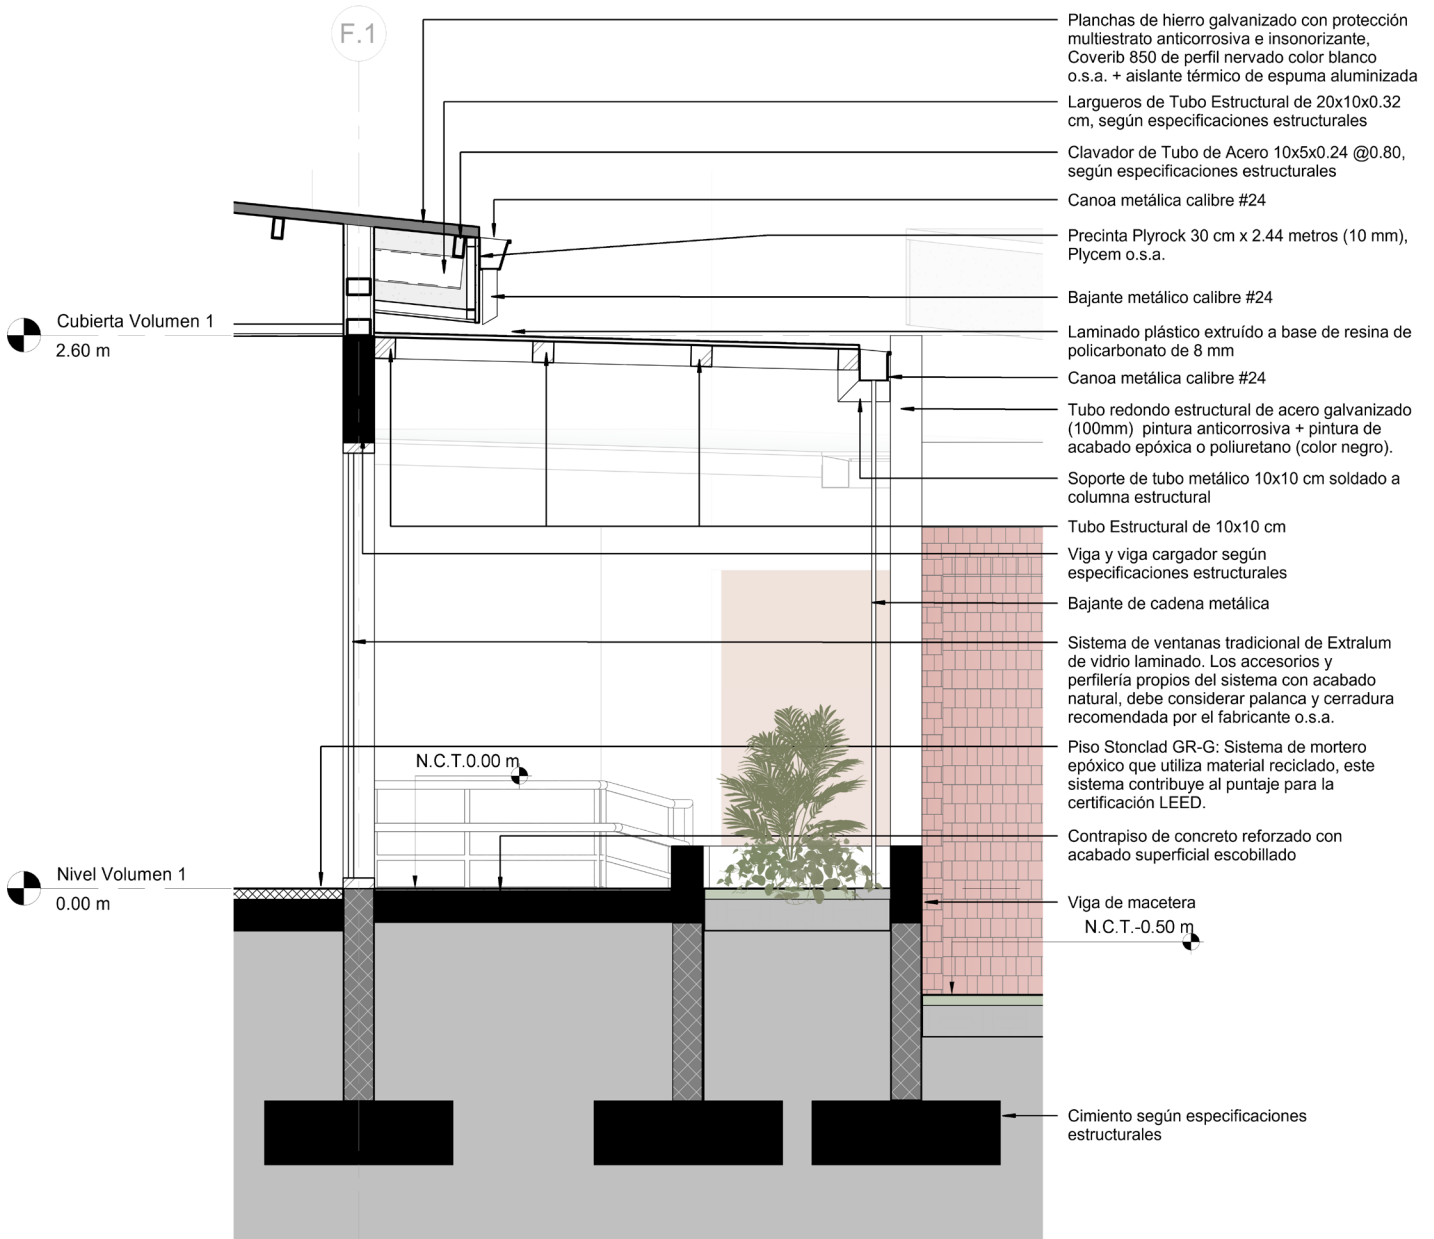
Detalle de Corte de Pared. Fuente: Elaboración propia
